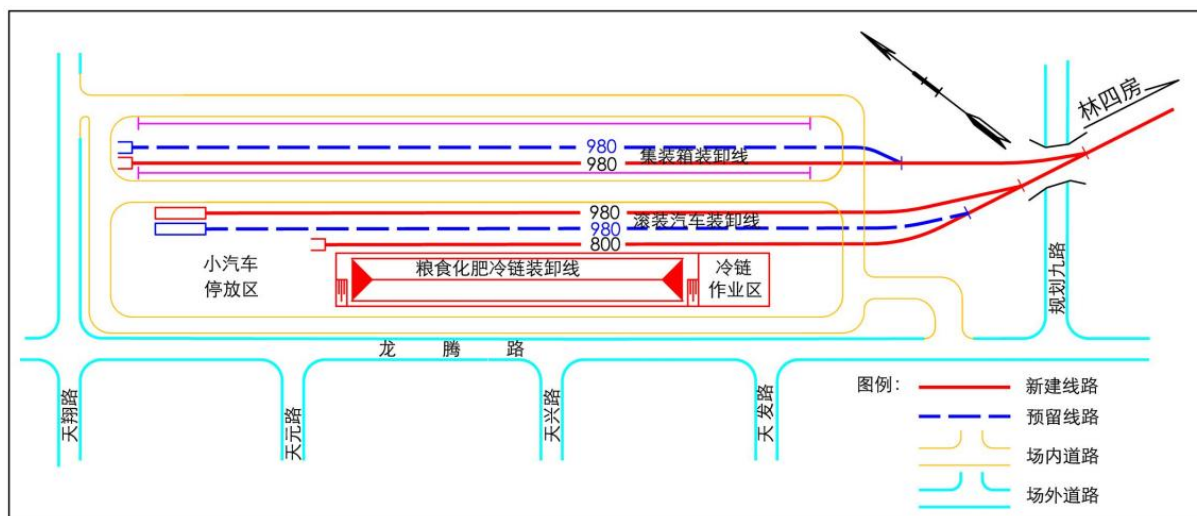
滚装汽车装卸区设置于场址中部装卸场平面布置示意图
